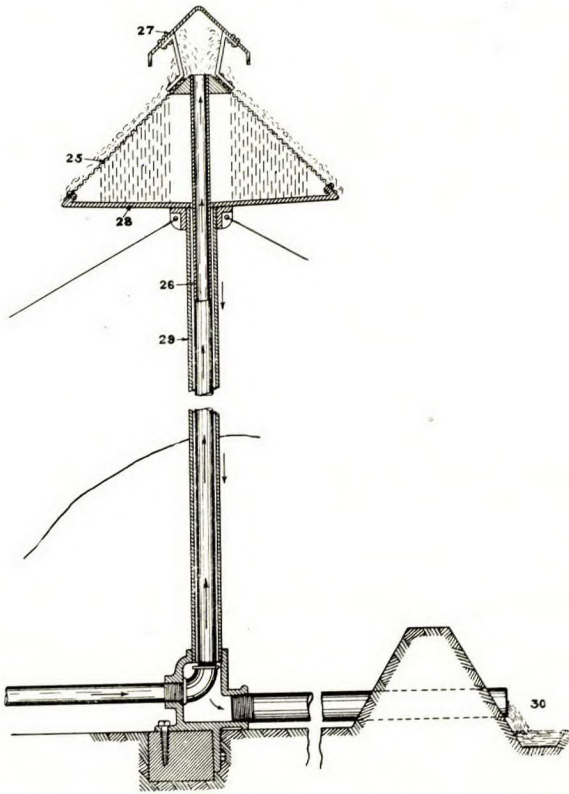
Coupe verticale de l'installation hydraulique Bernard Granville.
